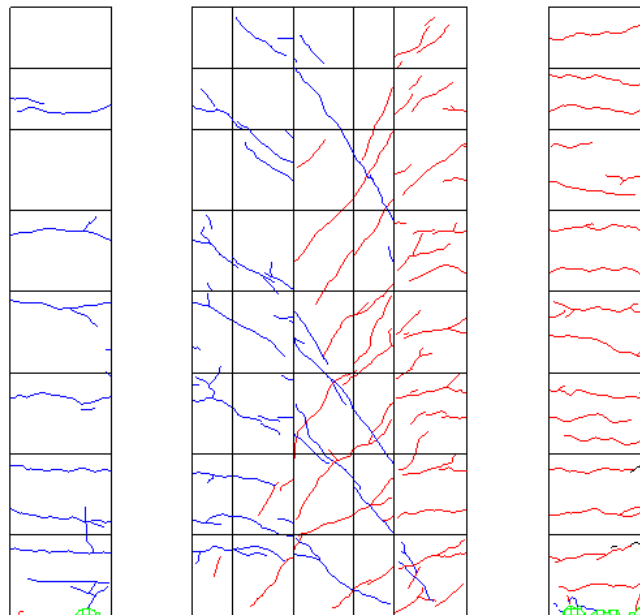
R=-1/67②ひび割れ図
